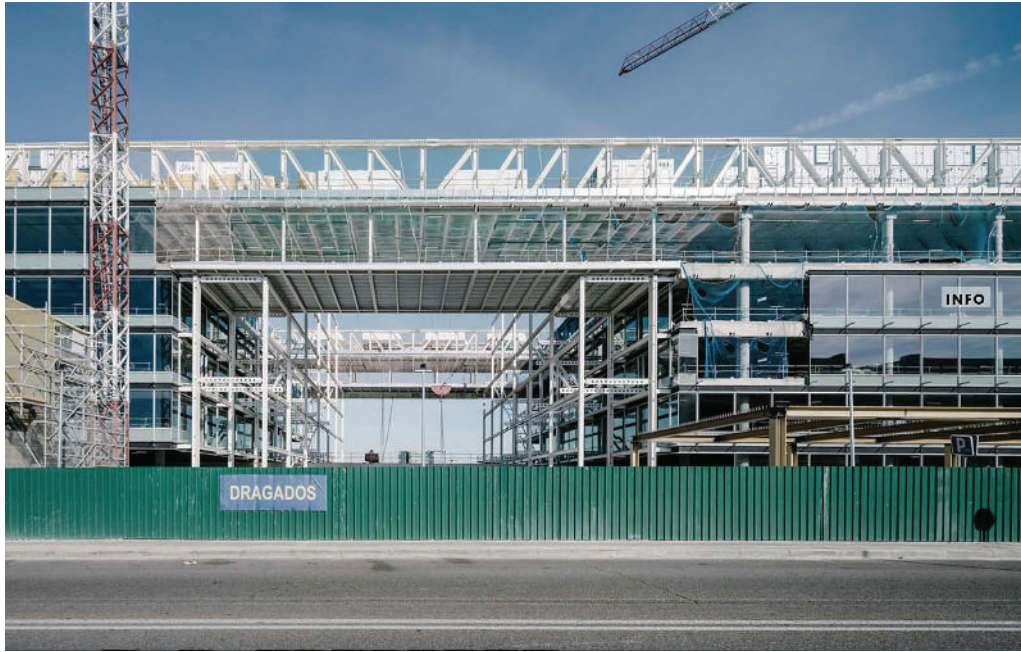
Puentes sur (primer plano) y norte (al fondo) entre bloques A y B, con planta cuarta suspendida.
